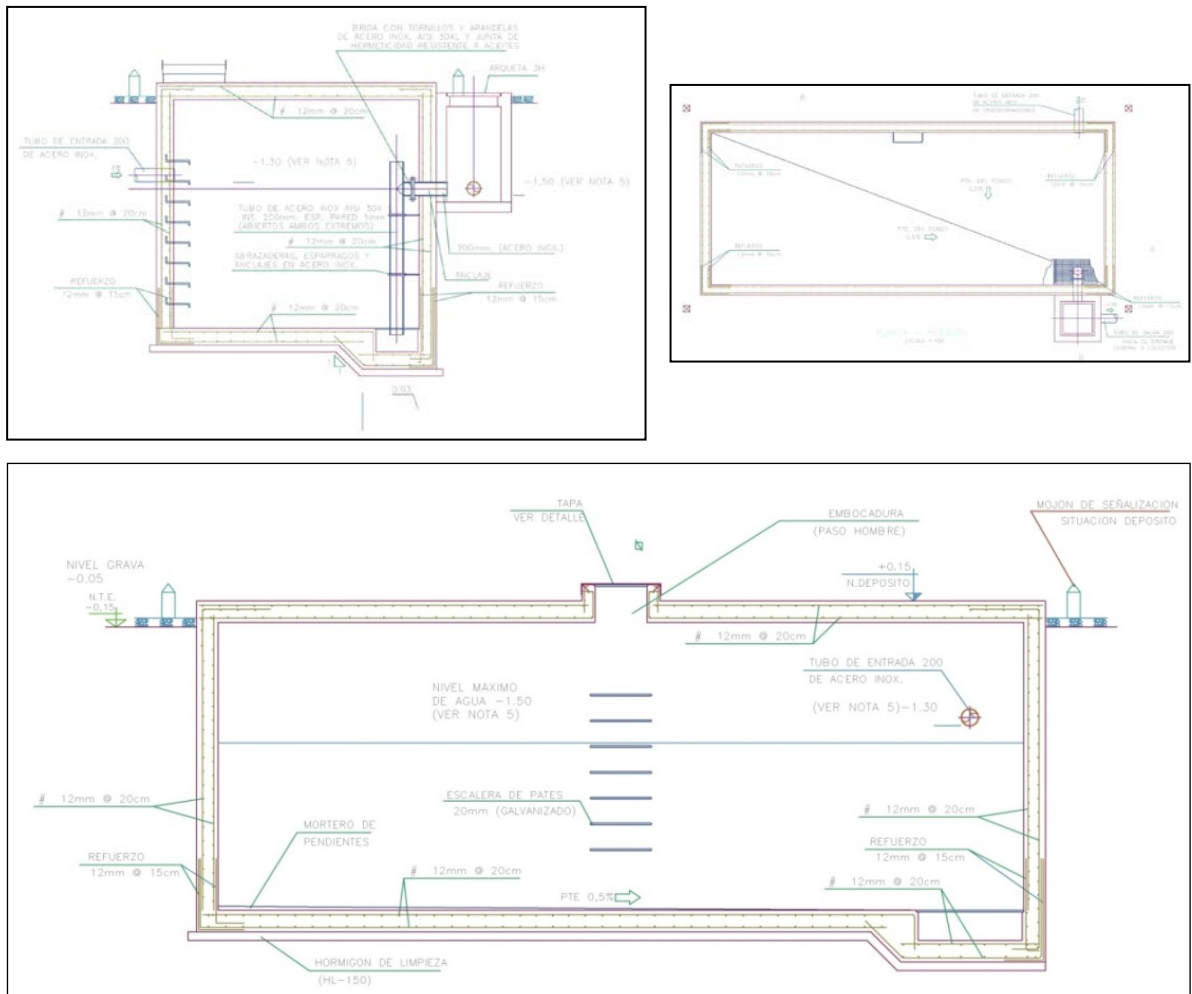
Perfil, planta y alzado de un depósito de recogida de aceites bajo bancada.
